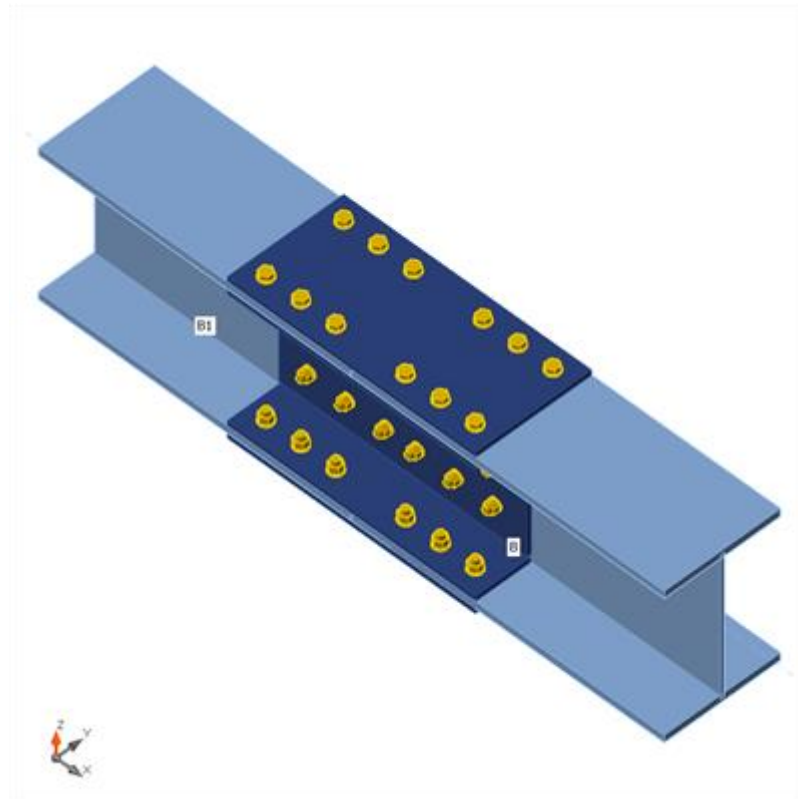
Vue d'assemblage poteau– poteau
